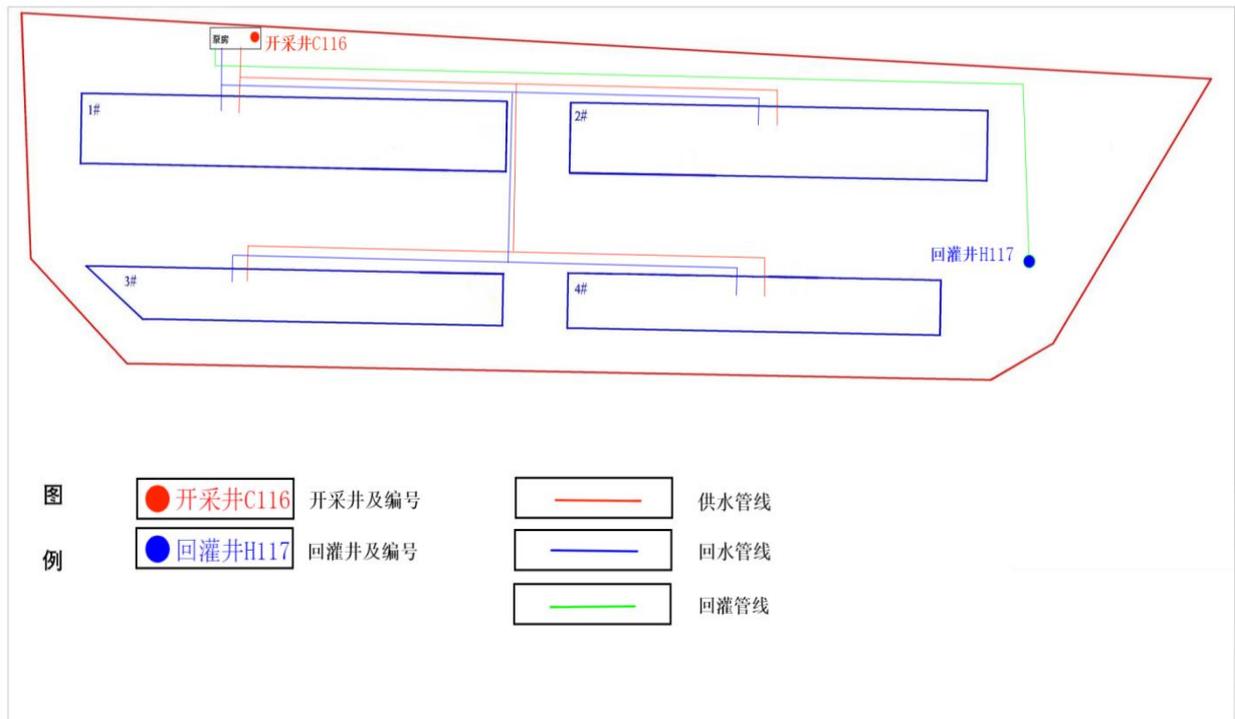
温馨花园供暖项目用热工程布置平面示意图
